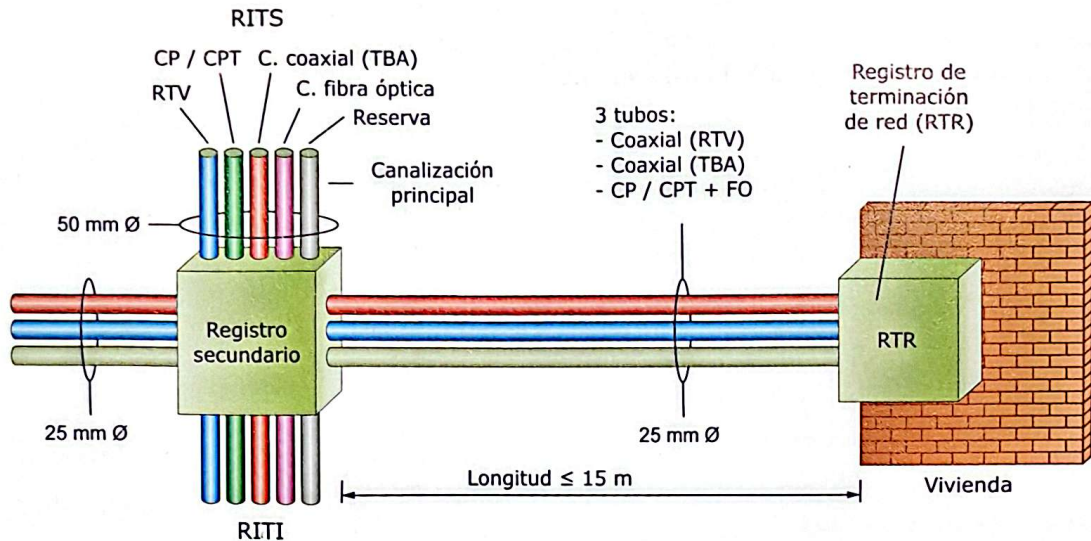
Canalización secundaria para menos de 6 PAU por planta.
